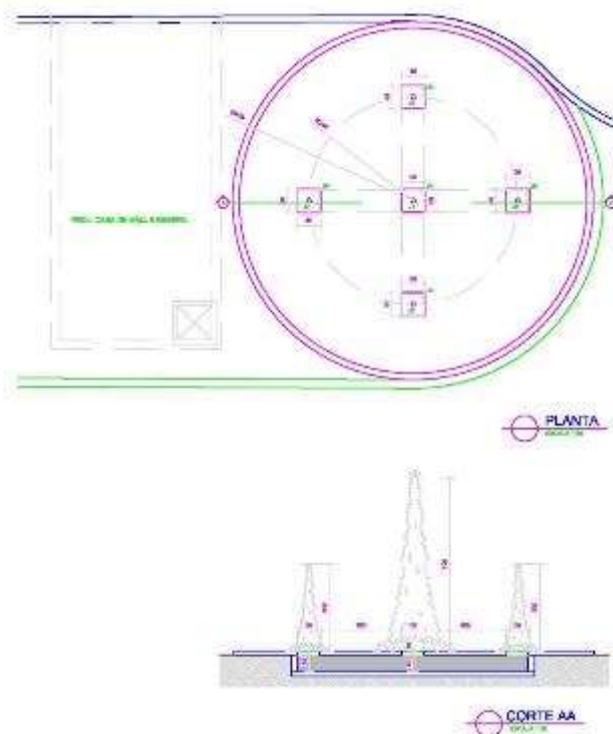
Imagem do projeto de arquitetura da fonte ornamental – planta baixa e corte.
